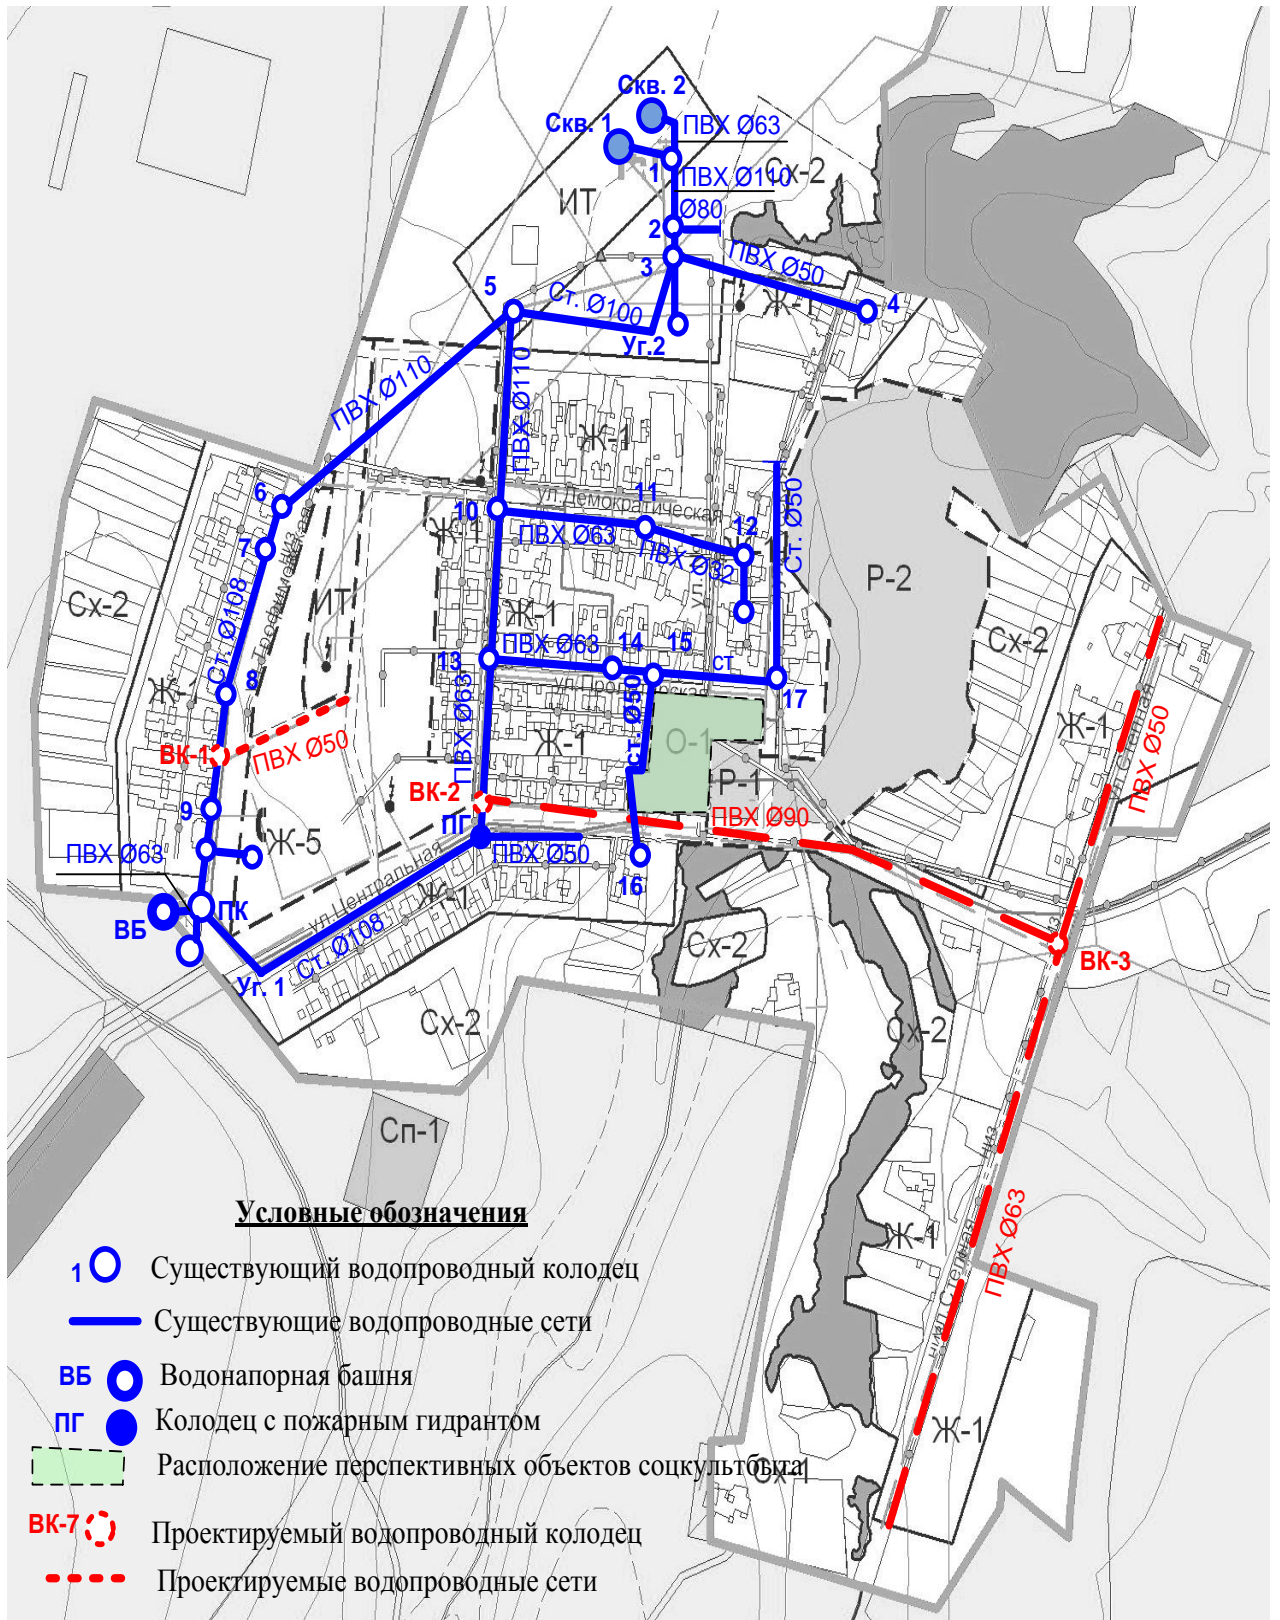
План развития водопроводных сетей села Тимофеевка до 2033 г.
